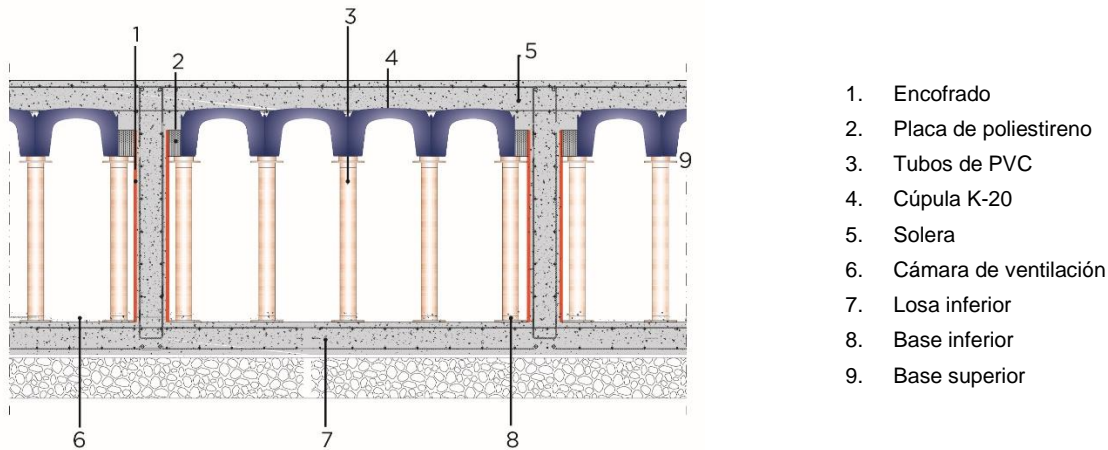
Alzado de un suelo elevado con el sistema K-Due.
